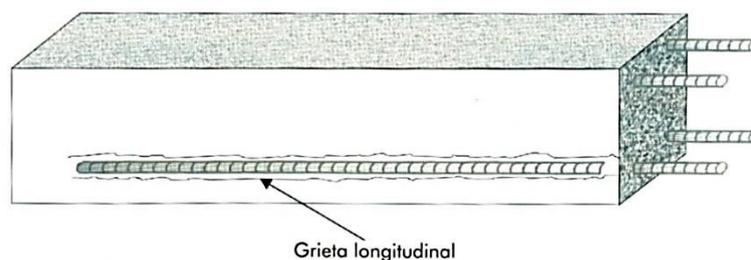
28 GRIETAS LONGITUDINALES POR FALTA DE ADHERENCIA.
